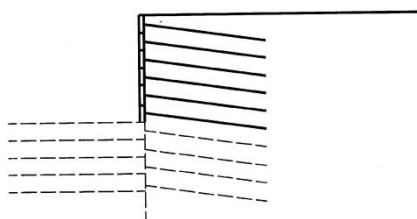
Escavação com parede vertical, adaptada (EN 14490:2010 (E))
